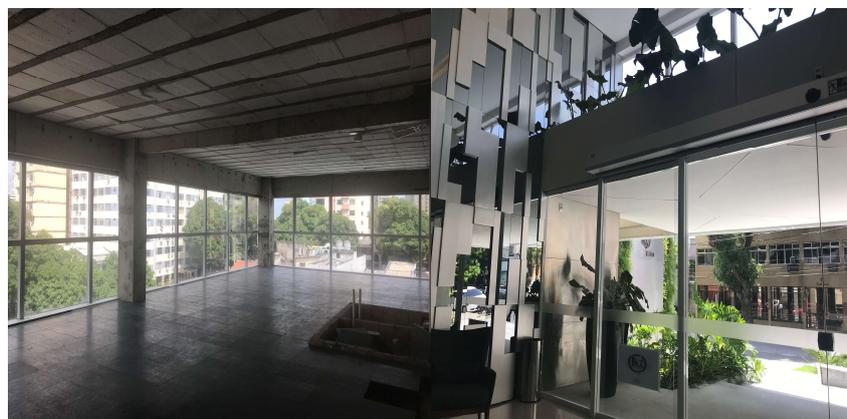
Vista das áreas envidraçadas nas fachadas: Torre Infinito, Belém.
